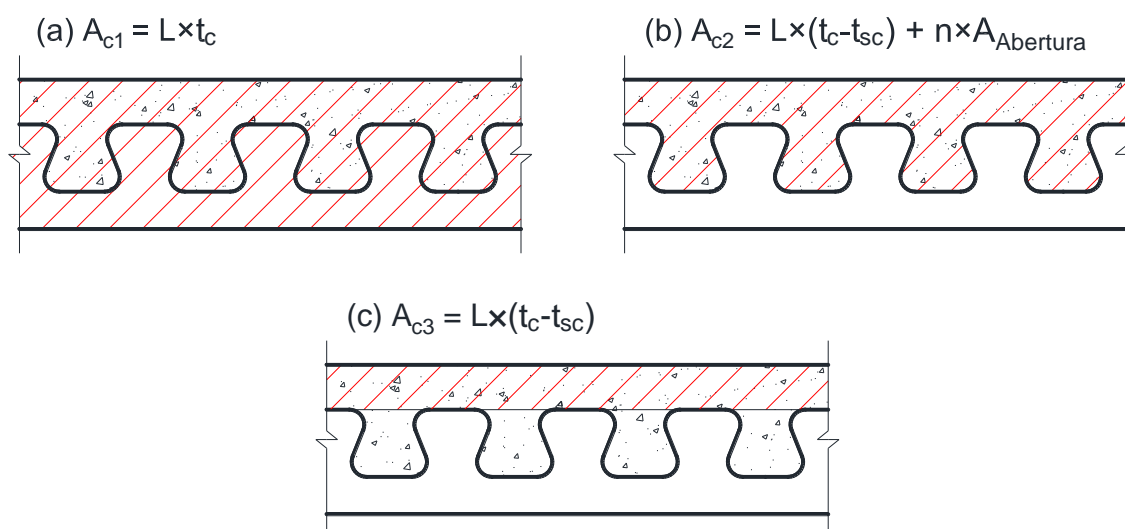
Áreas de concreto para cálculo da taxa de armadura transversal.
